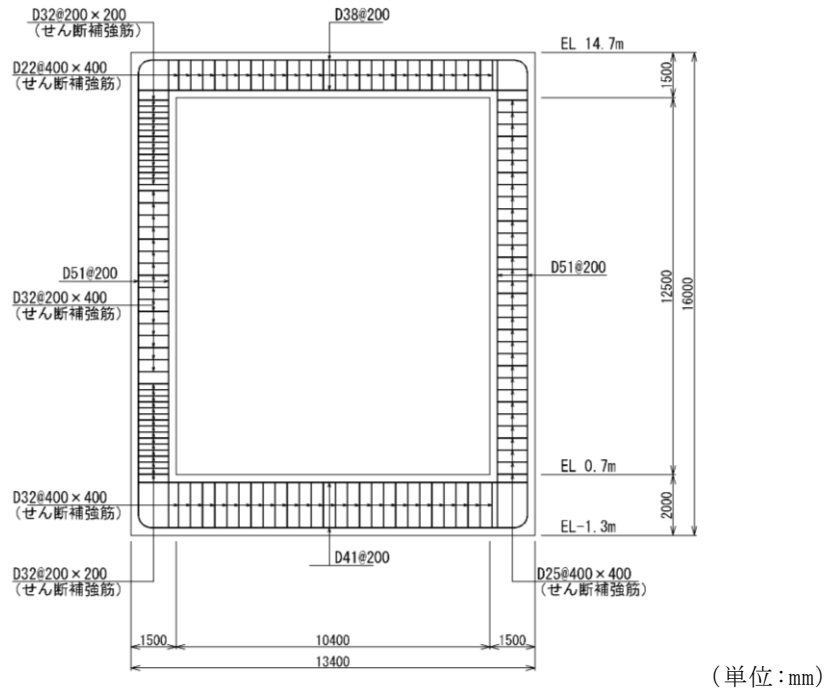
低圧原子炉代替注水ポンプ格納槽 概略配筋図 (B-B 断面)
